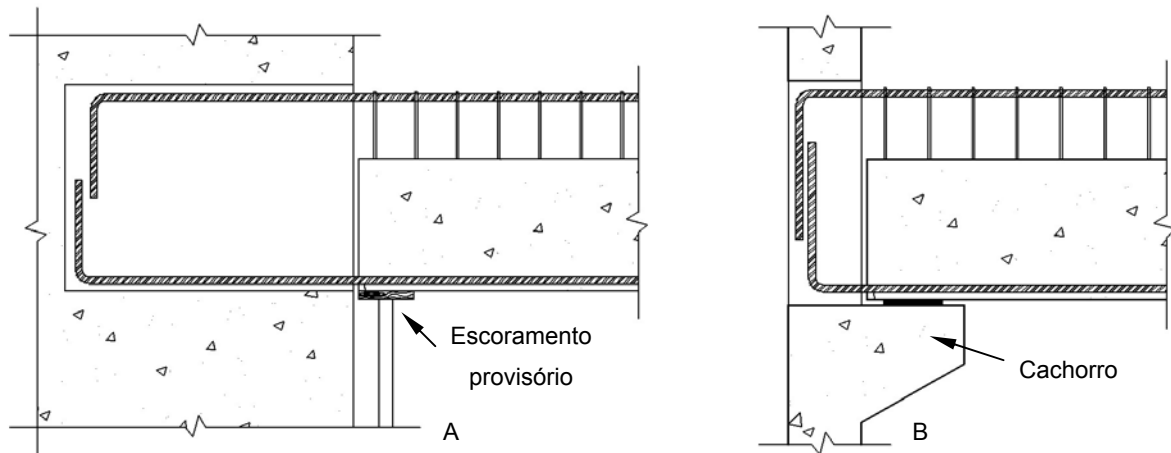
Ligação viga – parede resistente, A – ligação paralela, B – ligação perpendicular
